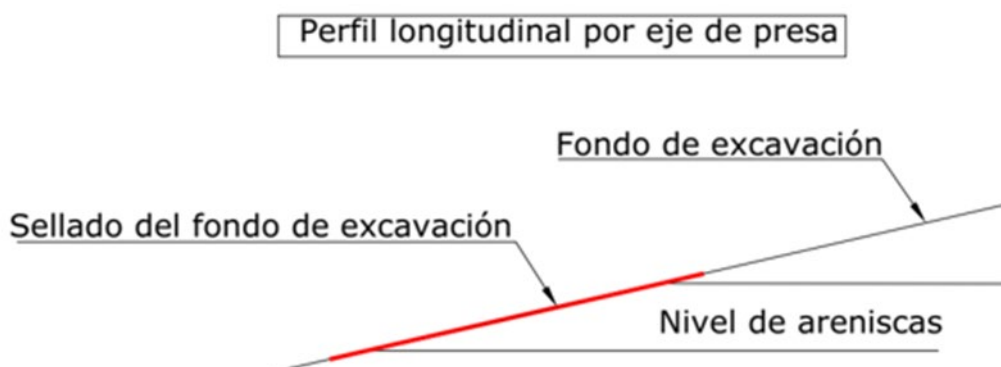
Sellado con hormigón proyectado del fondo de excavación
